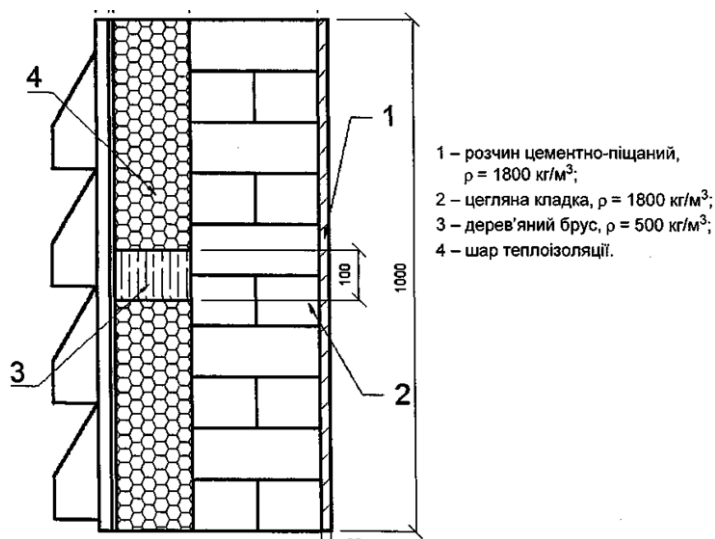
Типова конструкція вентиляваного фасаду
